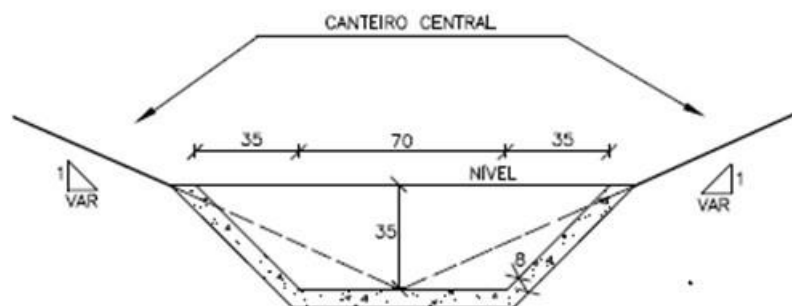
Sarjeta de canteiro central (Fonte: BRASIL, 2018).
